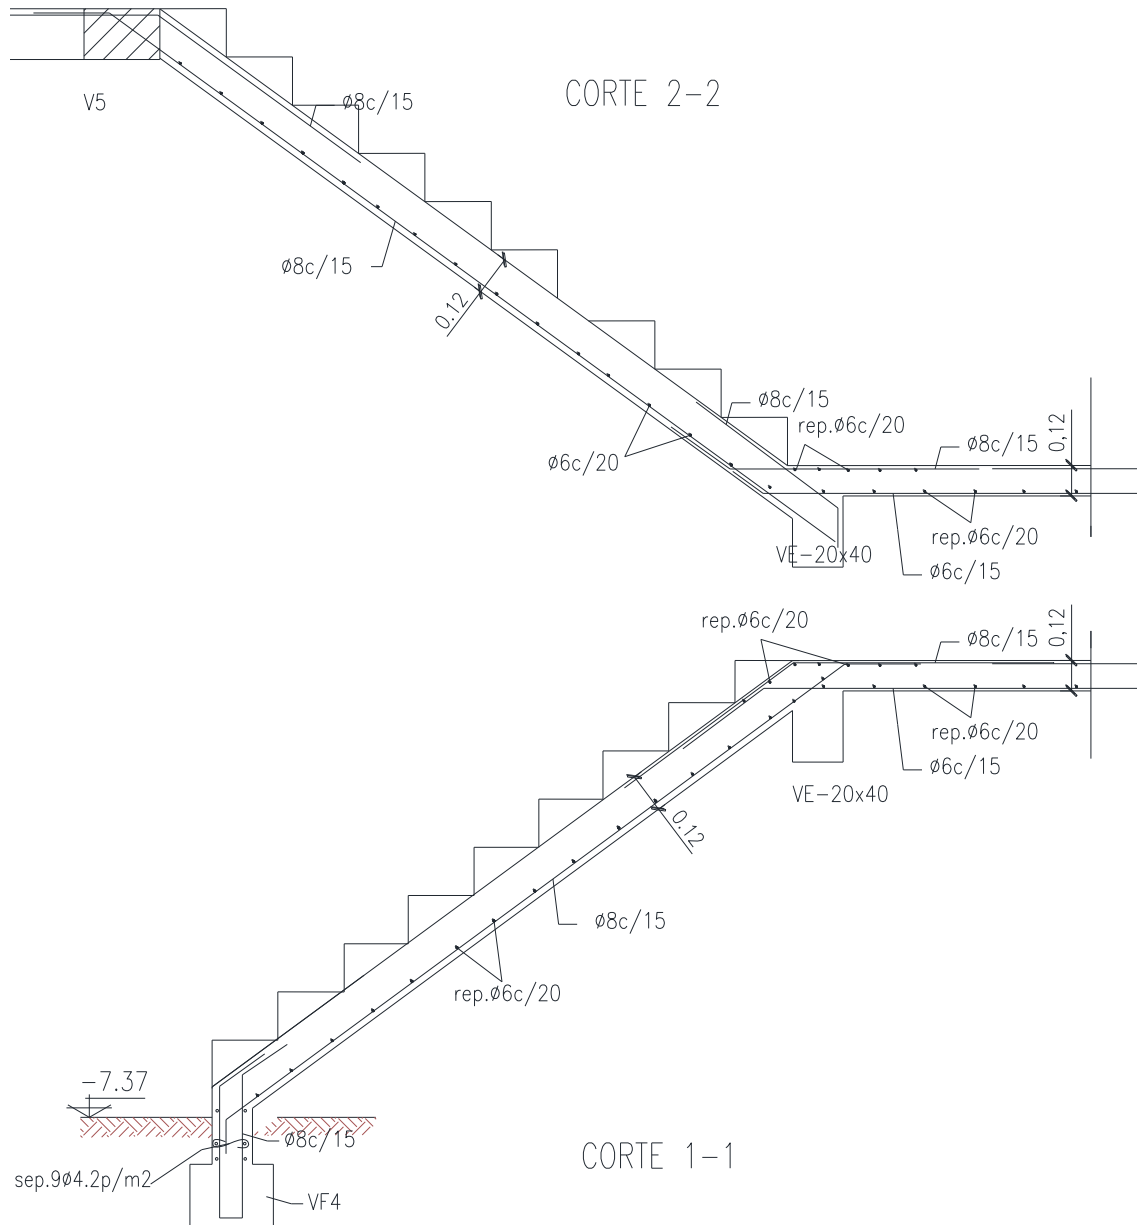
Corte de la estructura de la escalera de hormigón armado.
